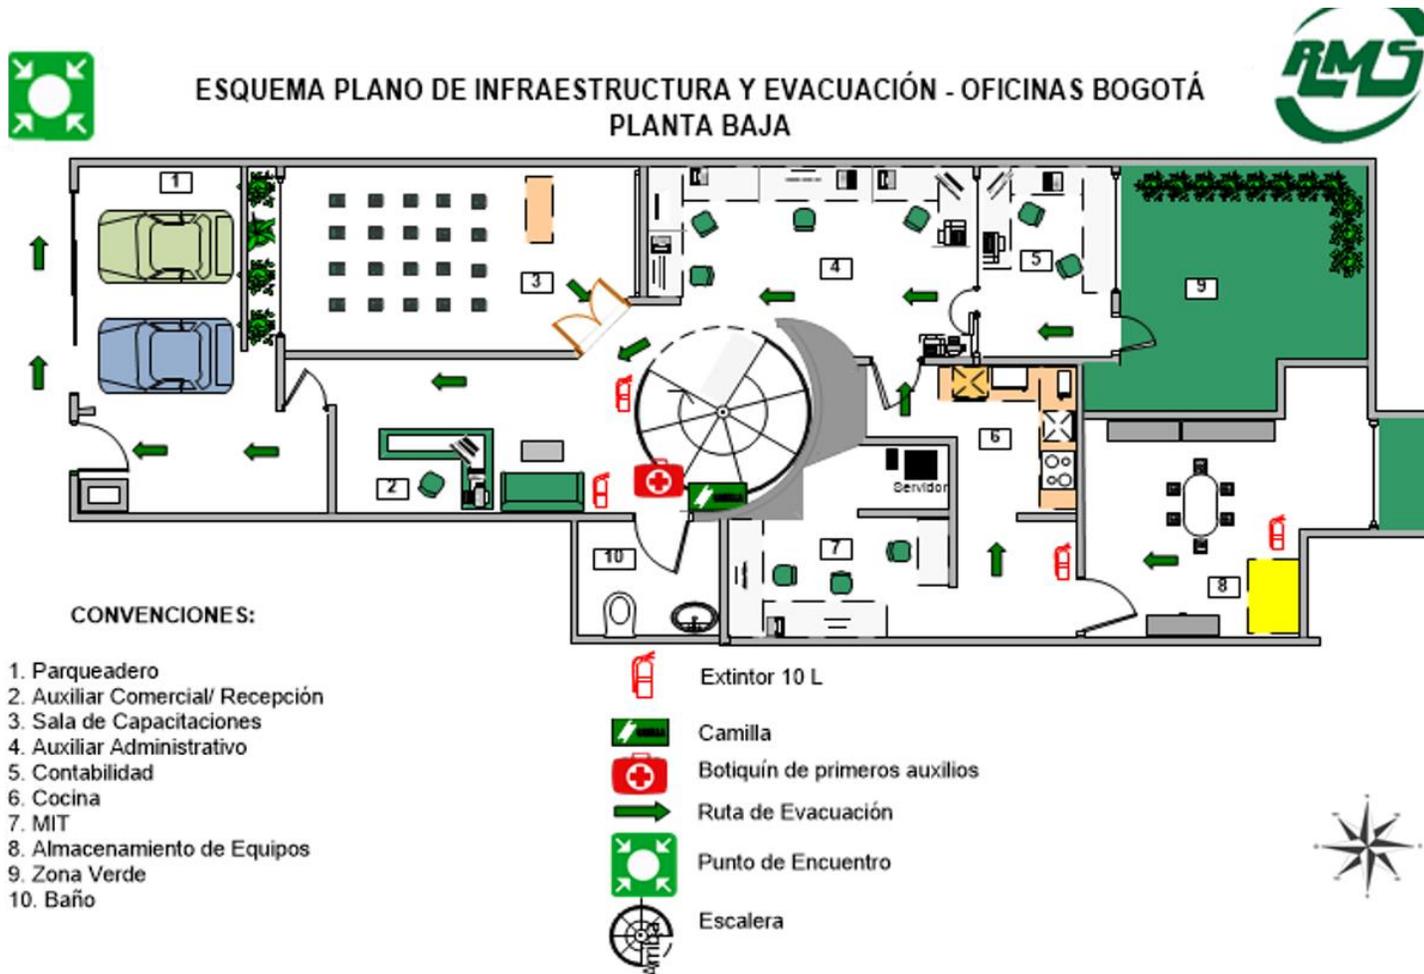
Planta Baja De Infraestructura Oficinas Bogotá.
